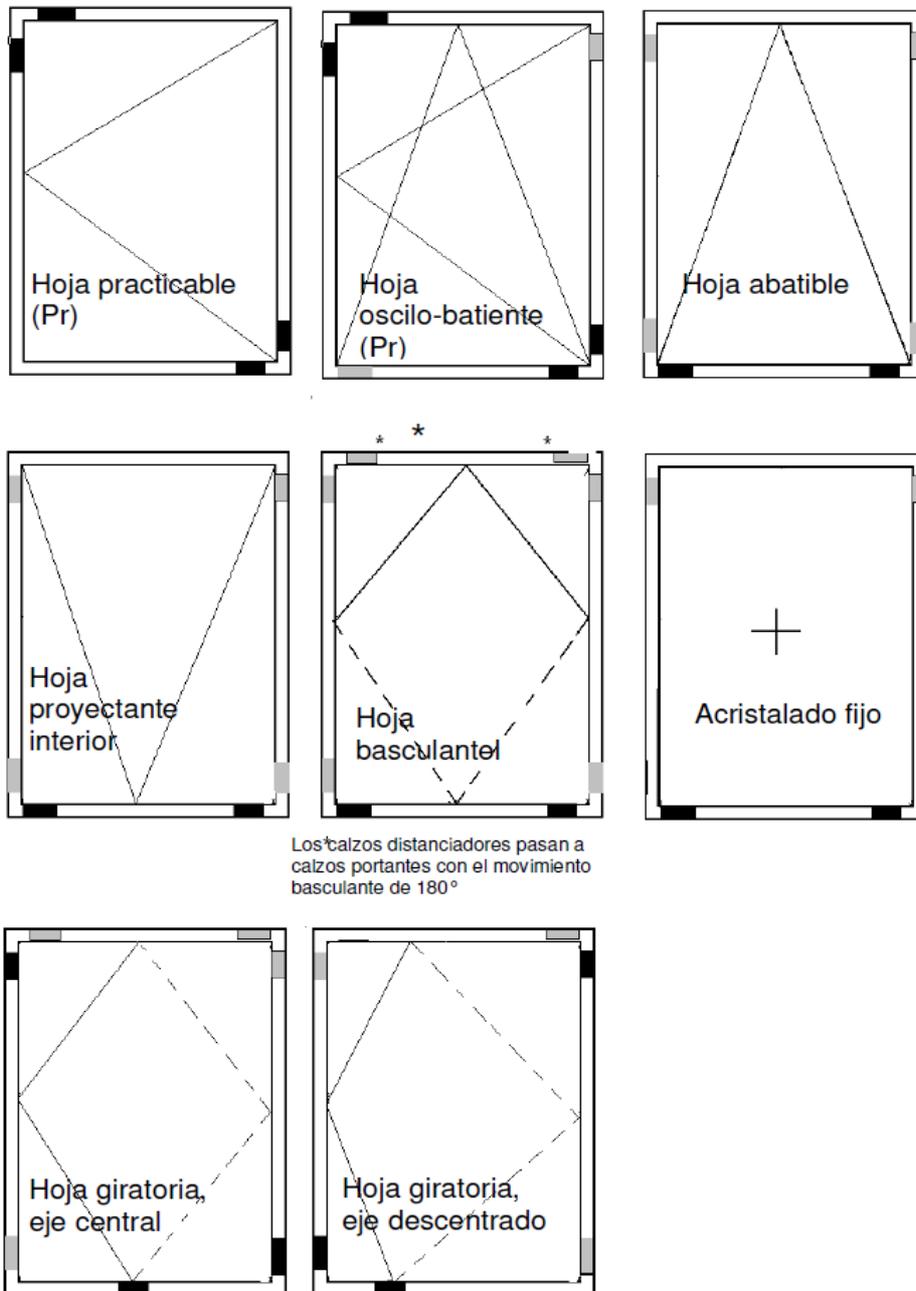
Esquemas de calzado en ventanas de madera según sistema de apertura.
